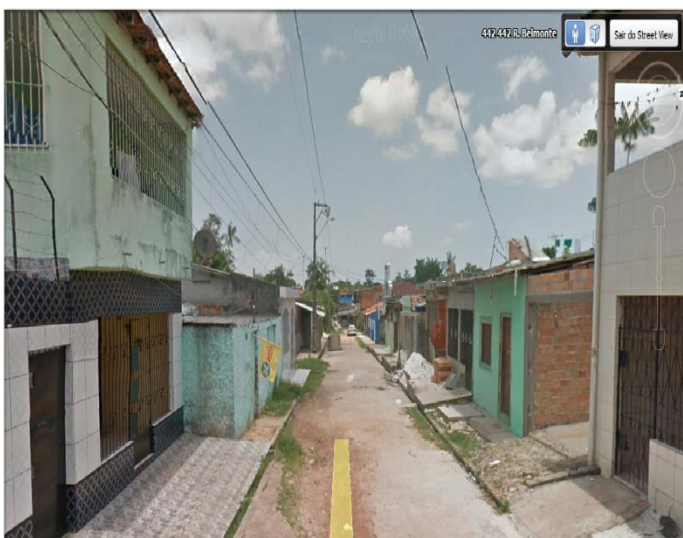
Tipologia de alvenaria. Rua não pavimentada, , ausência de drenagem, não existe plano de alinhamento, a autoconstrução é a principal forma de produção de casas, que não obedecem aos parâmetros estipulados pela legislação.
